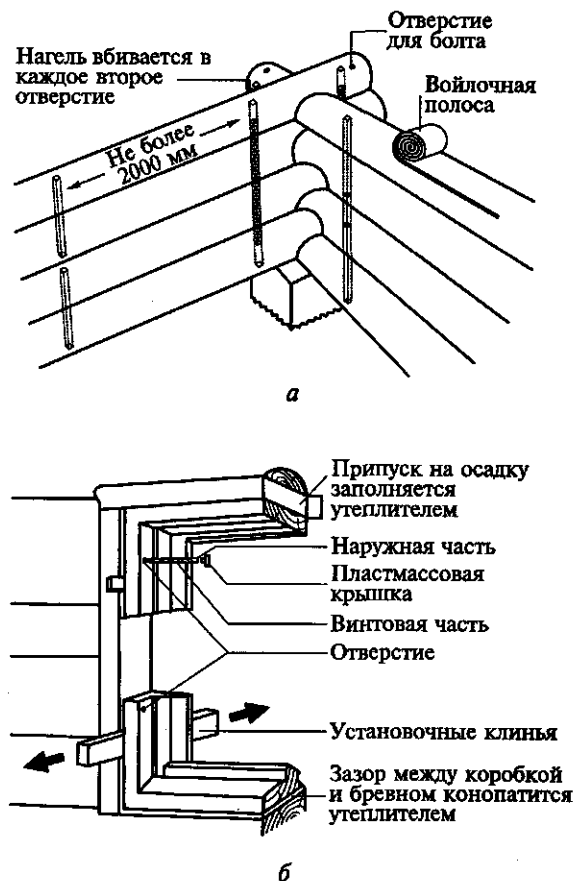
Возведение зданий из оцилиндрованных бревен:
